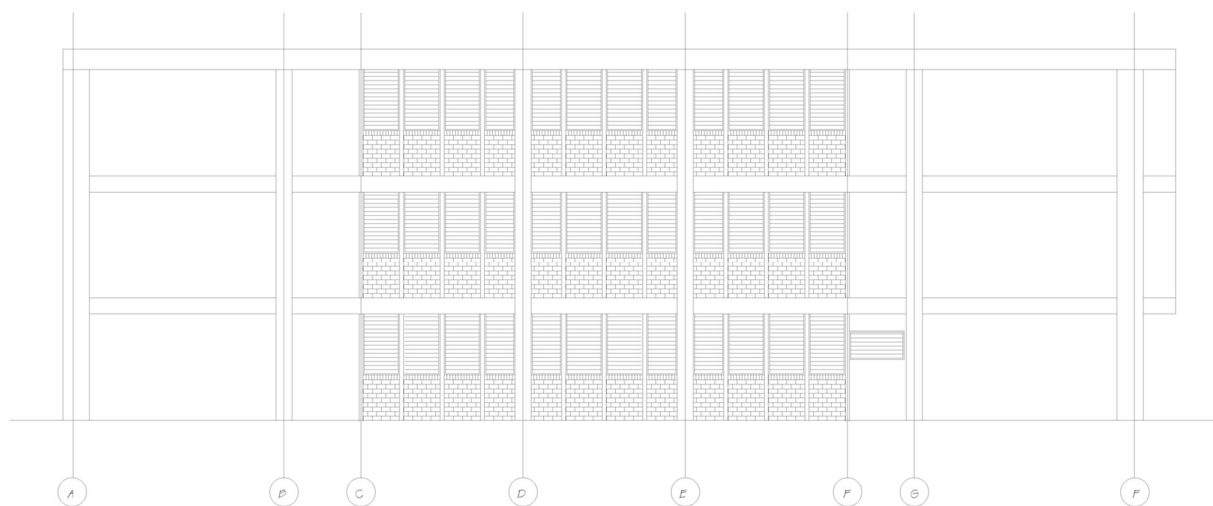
Planos Arquitectónicos – Fachada Lateral Izquierda.
